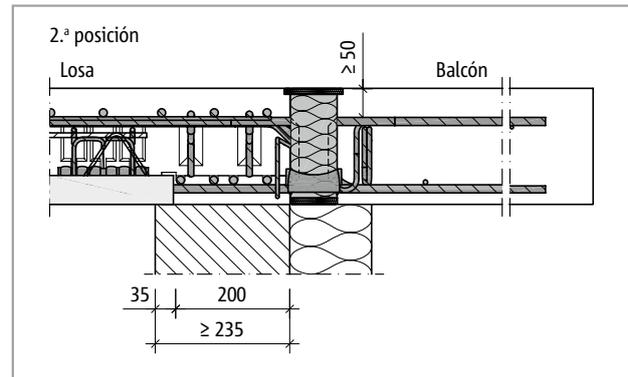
Schöck Isokorb® T tipo C: Placa prefabricada sin apoyo periférico con SATE (sección T tipo C-CV50-2.ª posición, vista T tipo C-CV35-1.ª posición)
